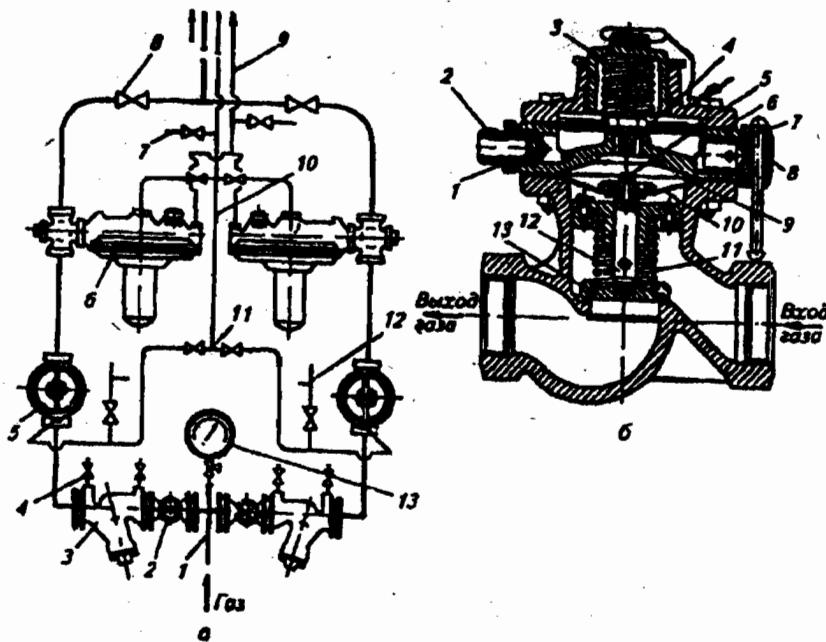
Устройство и схема обвязки шкафной ГРУ:
